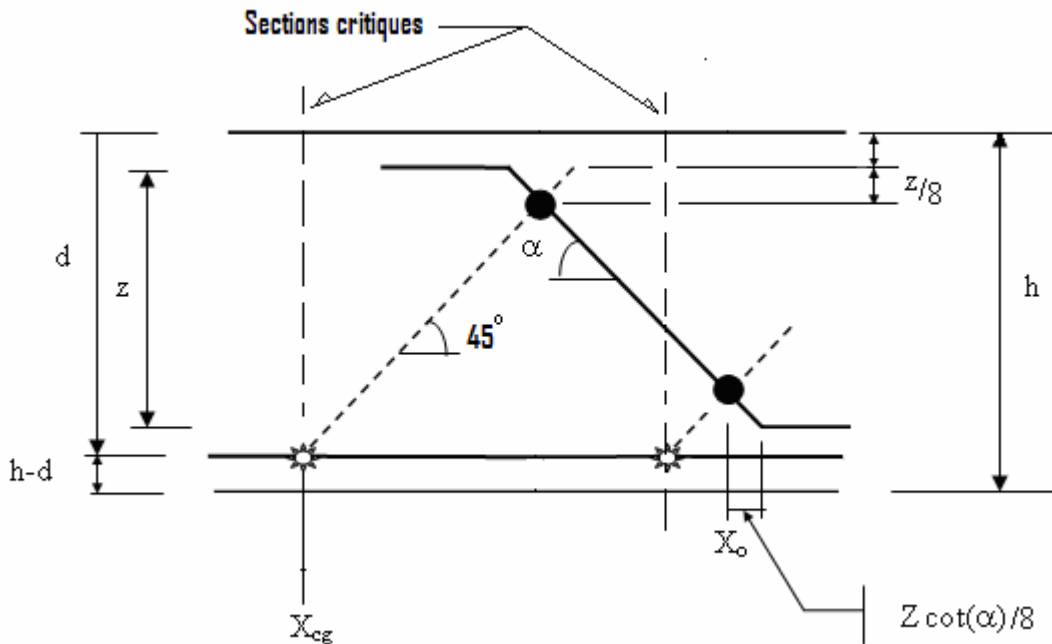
Sections critiques en cisaillement – barres pliées
